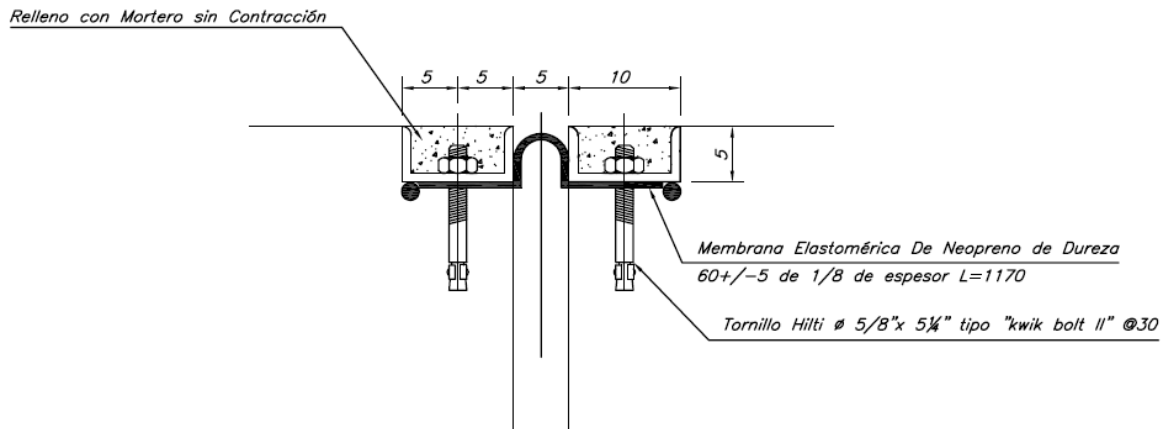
Detalle de junta expansión típica especificada en los planos de diseño.
